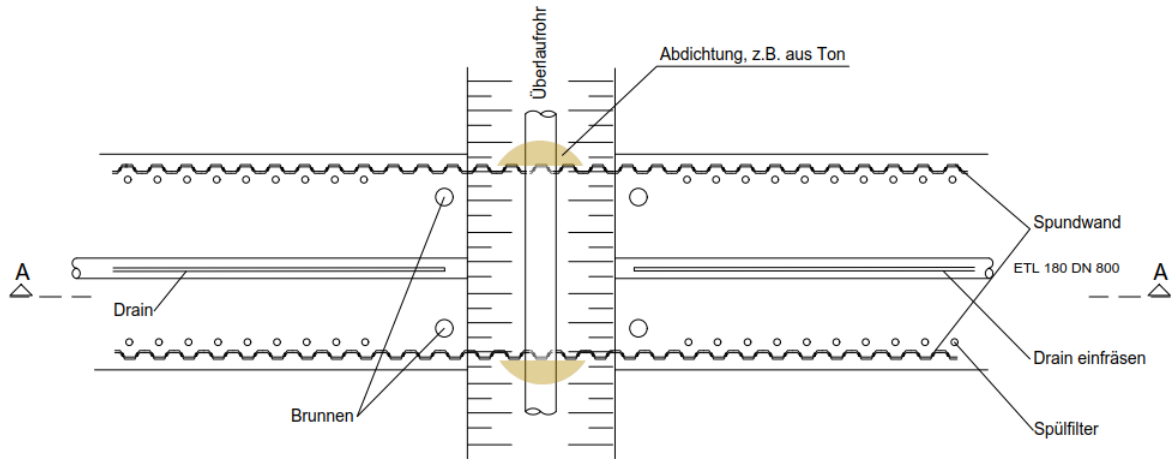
Draufsicht offene Gewässerkreuzung mit Überlaufrohr (nach Regelplan C10)
